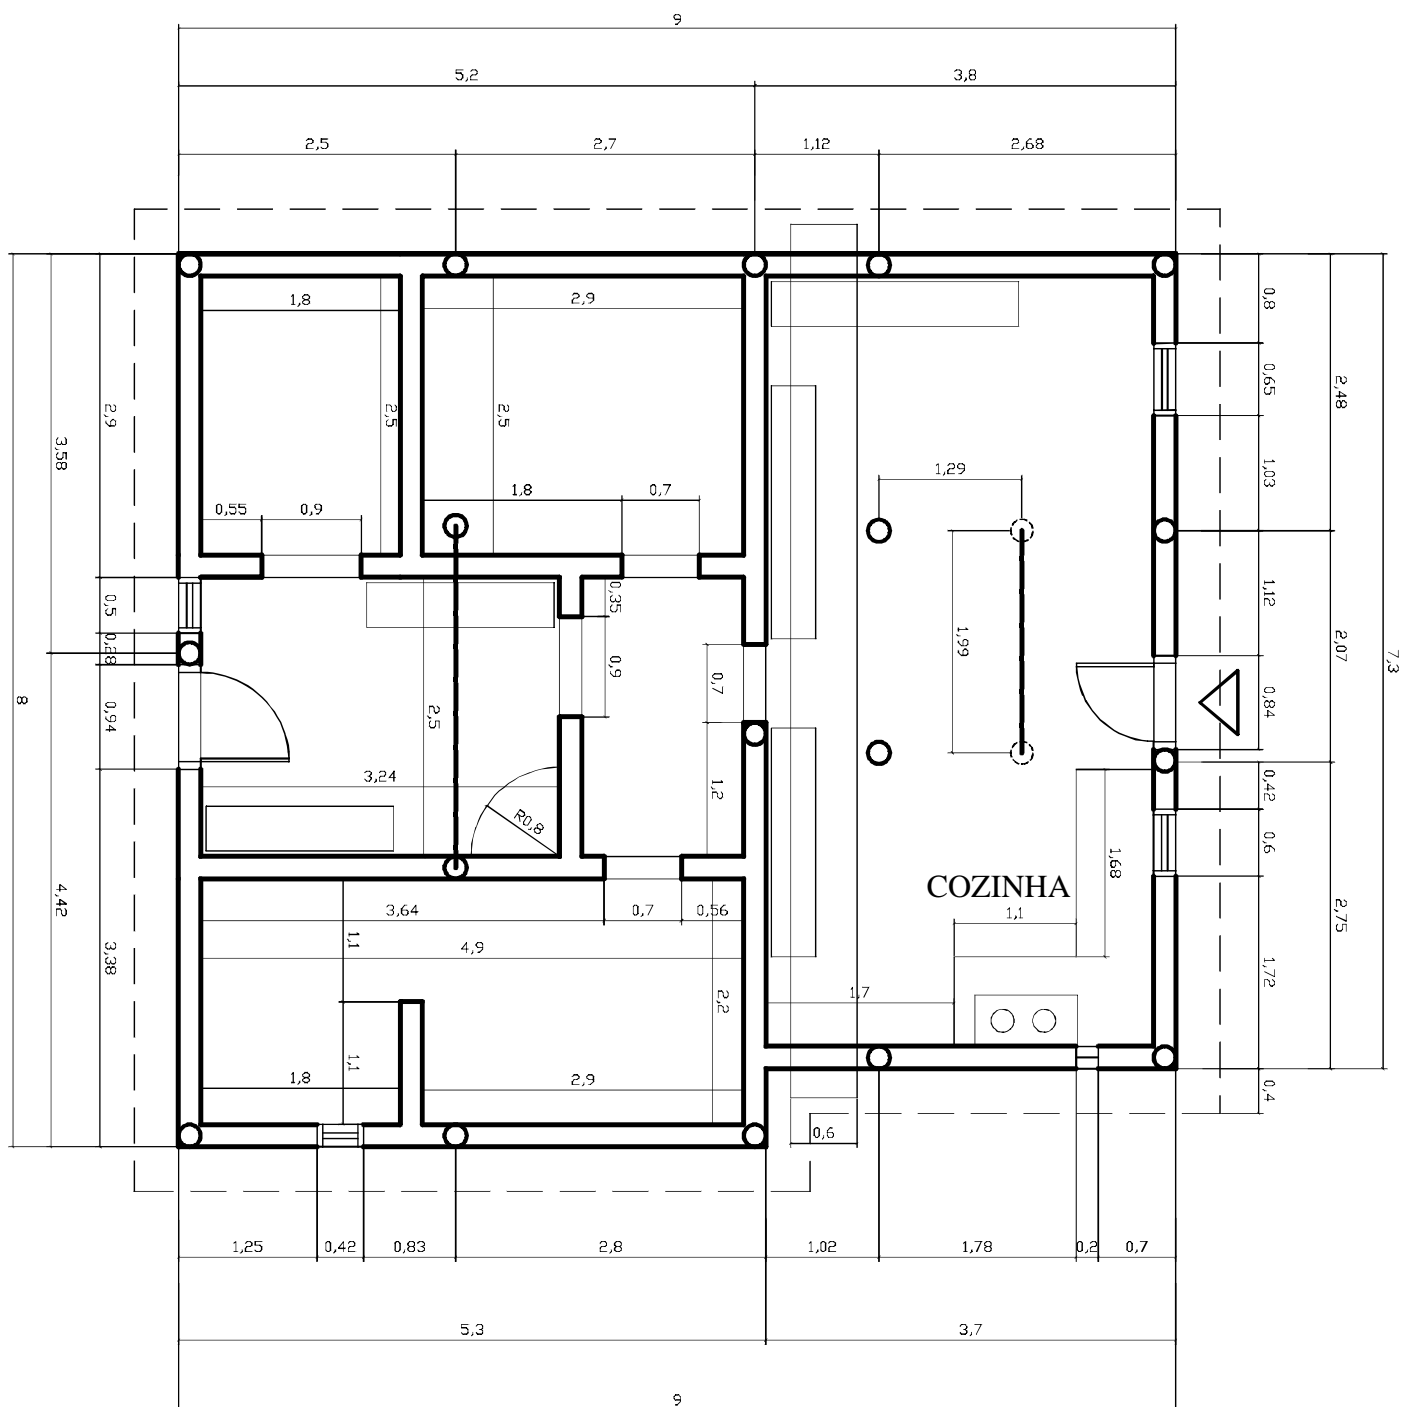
Planta Baixa de Casa Kalunga de adobe c/ estrutura de madeira. s/ escala. Medidas indicadas em metros. Fonte: Levantamento Fubra/Cantoar-UnB
